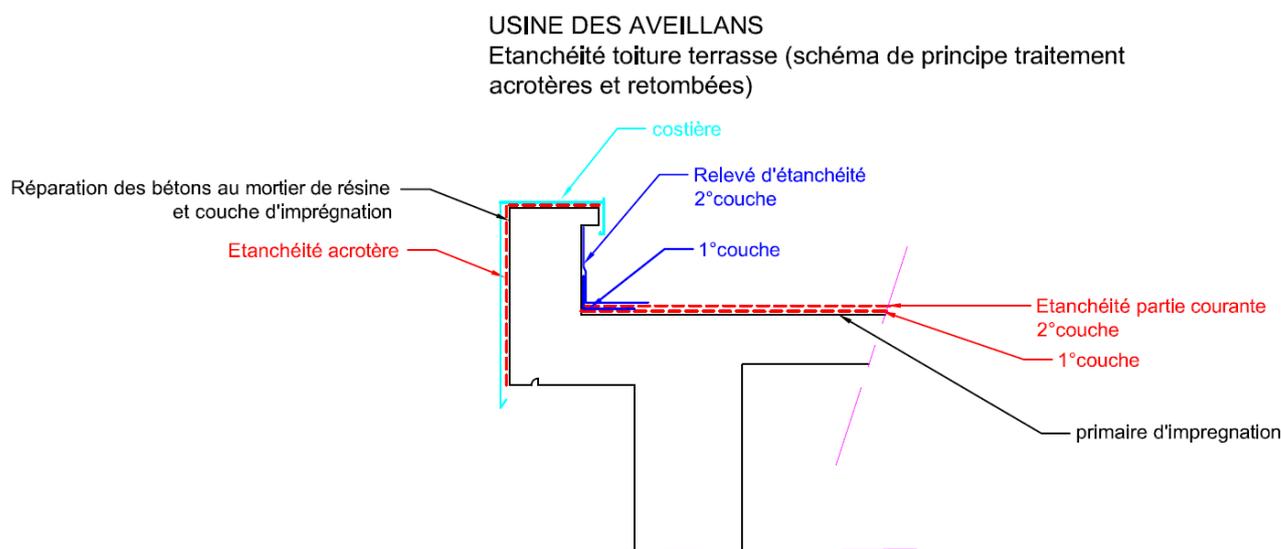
Toit terrasse – schéma de principe du revêtement d'étanchéité sur l'acrotère à proximité du transformateur
